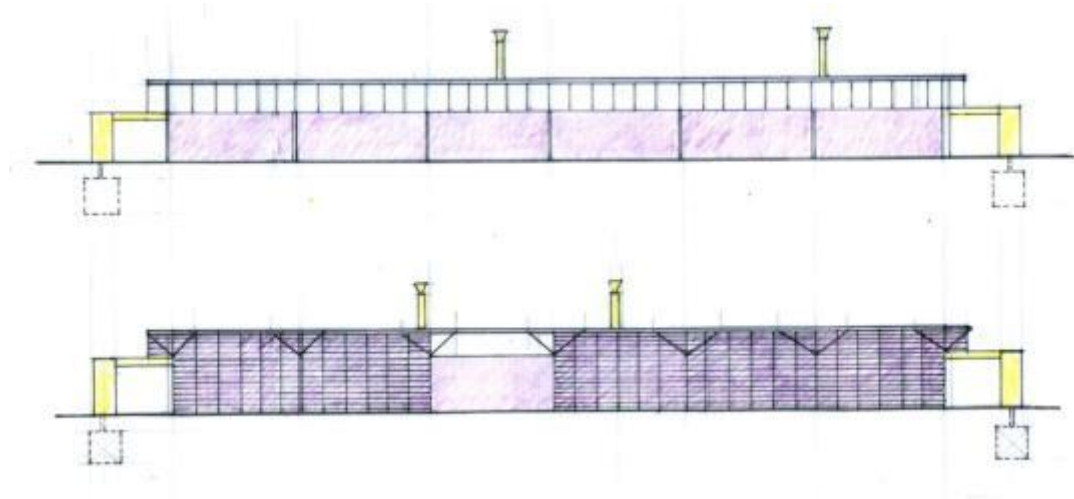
Fachada sur y norte. Croquis realizado por el autor.
